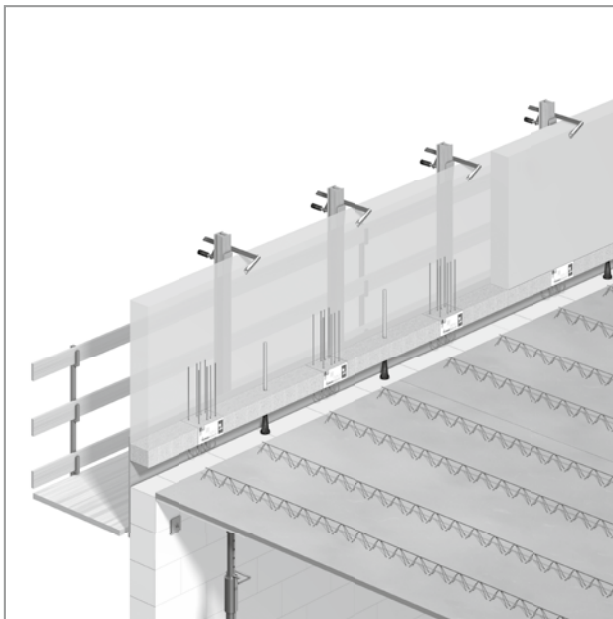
Schöck Isokorb® XT tipo A con soporte de montaje Combar® FT: Fijación del peto prefabricado alineado
